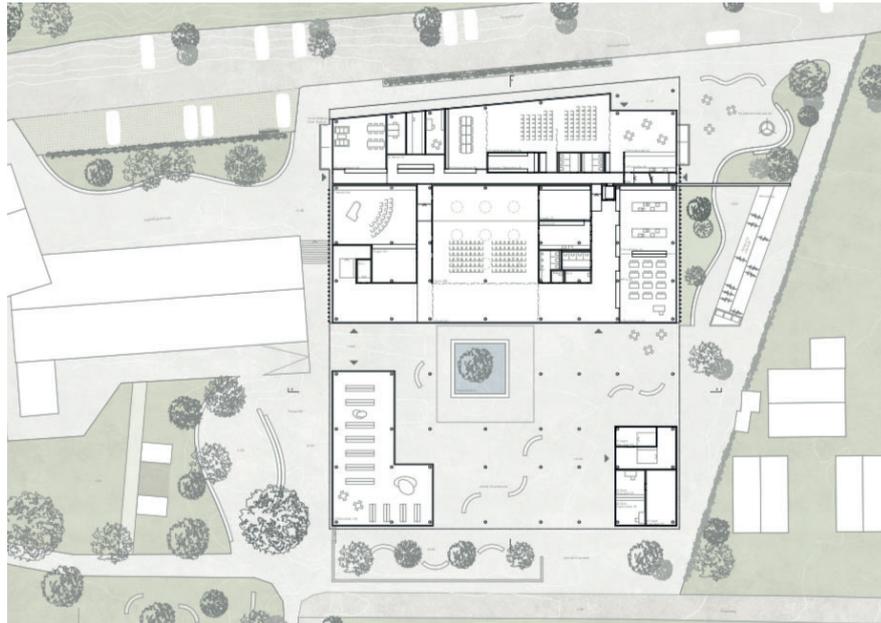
Grundrissplan Erdgeschoss mit Aussenräumen
